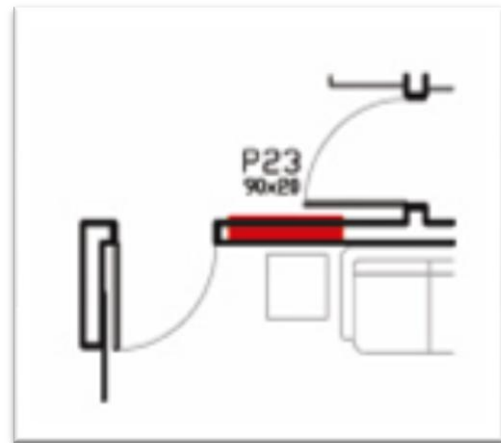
Planta baixa desalinhamento de pilar e parede.
